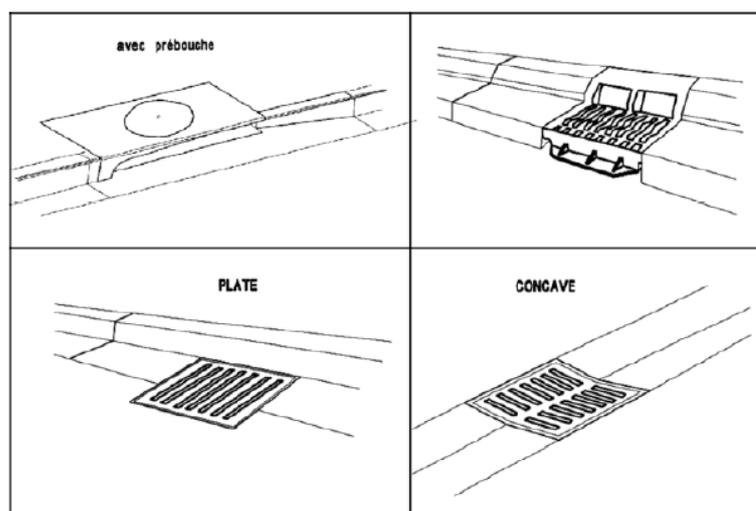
Les bouches d'égout (Seddiki, 2019)
